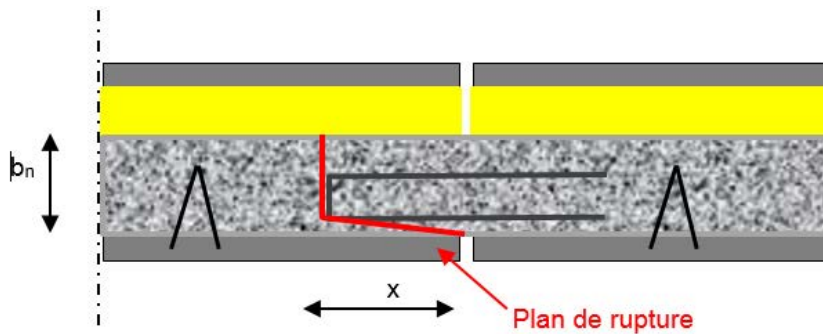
Liaison sans couture aux abuts, avec noyau non armé côté isolant (hors poutre voile)
